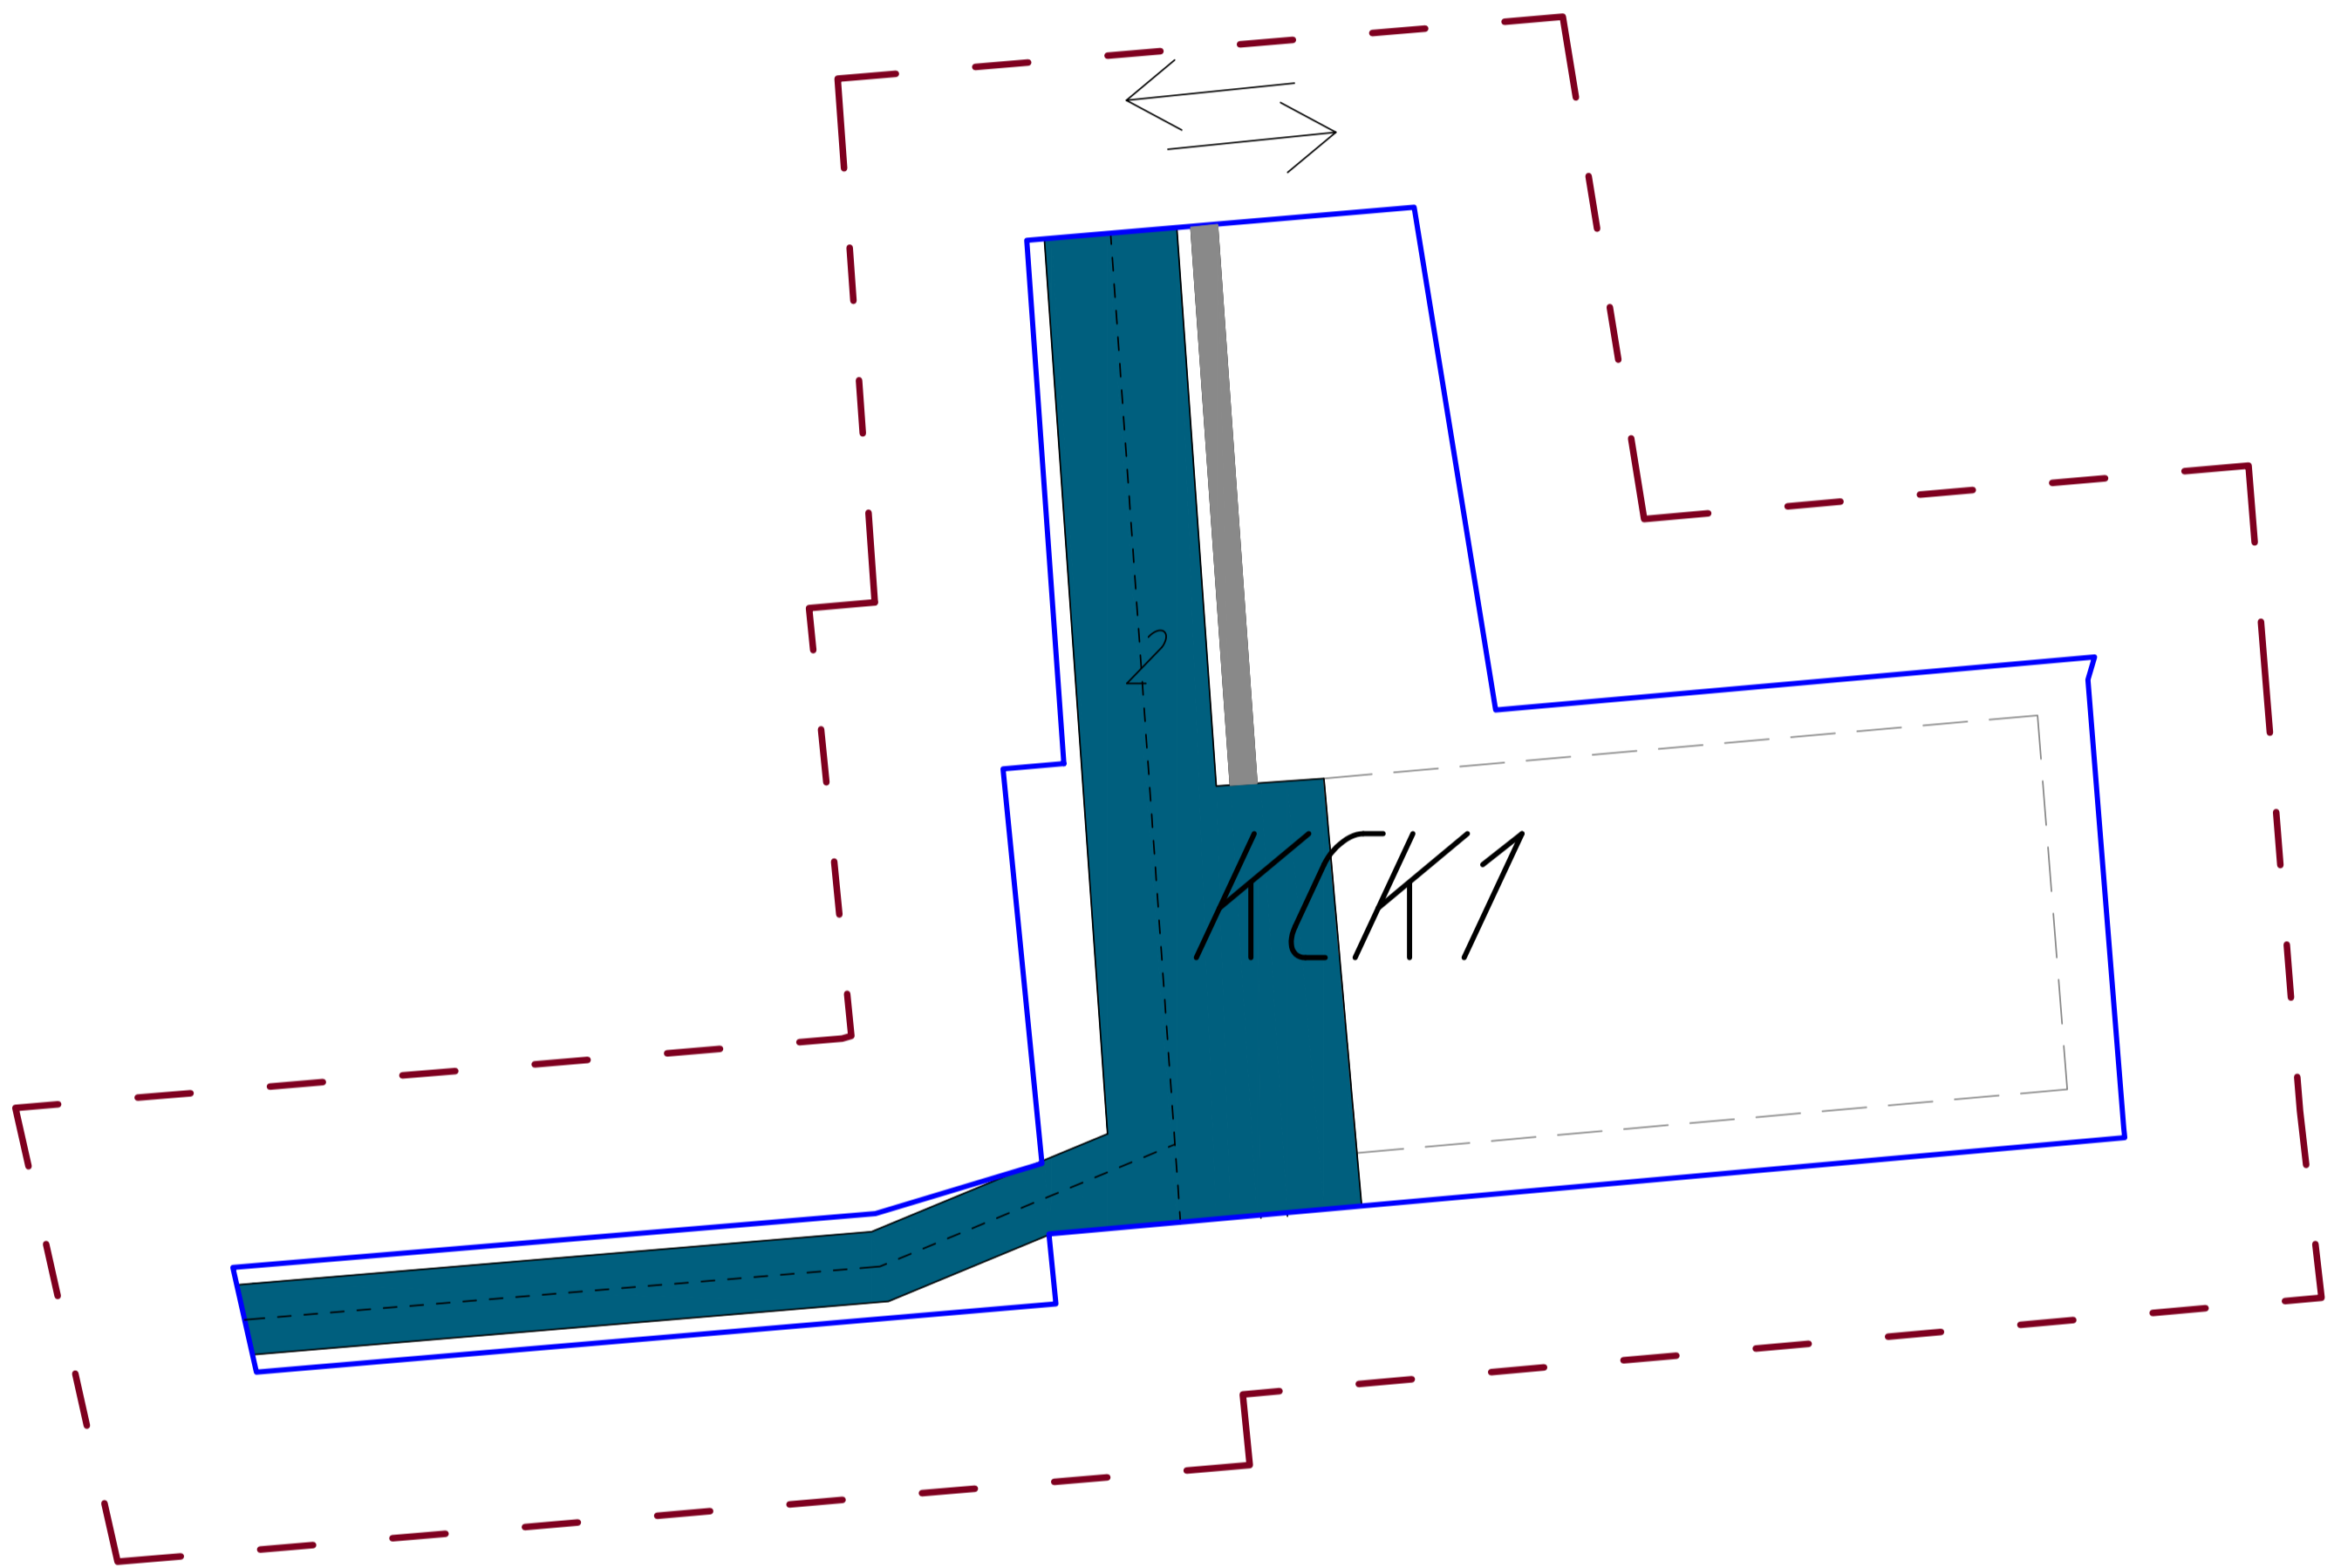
Фрагмент карты функциональных зон генерального плана
